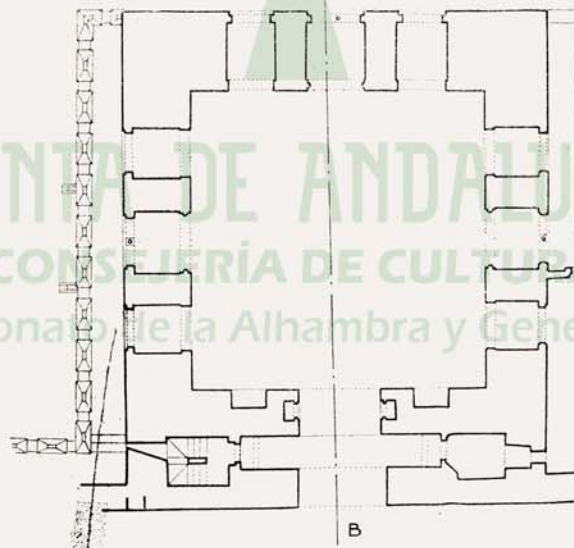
Plano de la 2.ª planta, correspondiente al Salón de Embajadores, en su estado actual
